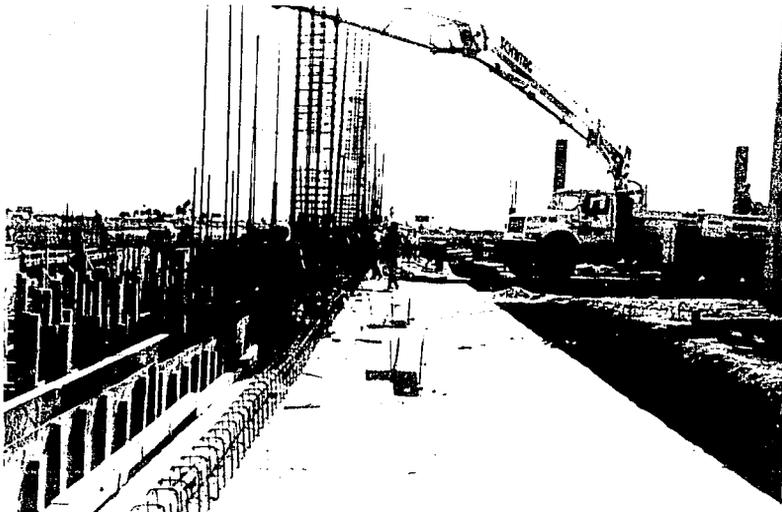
CIMENTACIÓN. MUROS LATERALES Y TRANSVERSALES COLADOS; CIMBRADO Y ARMADO DE LA LOSA TAPA Y TRABE PERIMETRAL; CONTINUACIÓN DEL ARMADO DE LAS COLUMNAS.
